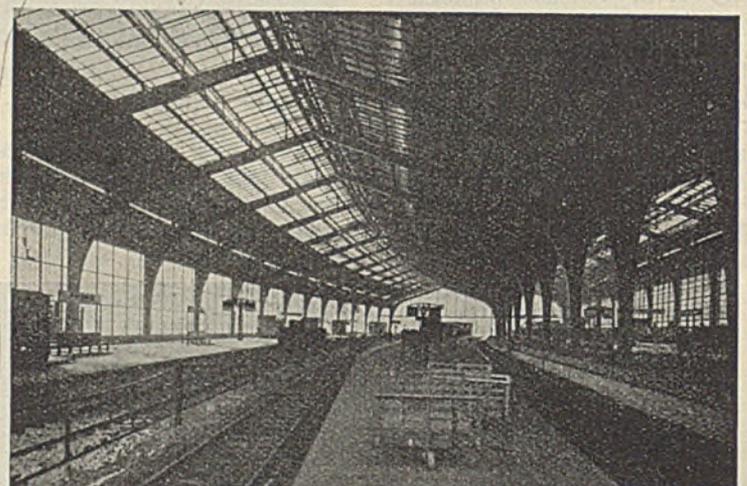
Bahnhofshalle Berlin Friedrichstraße. Innenansicht.
